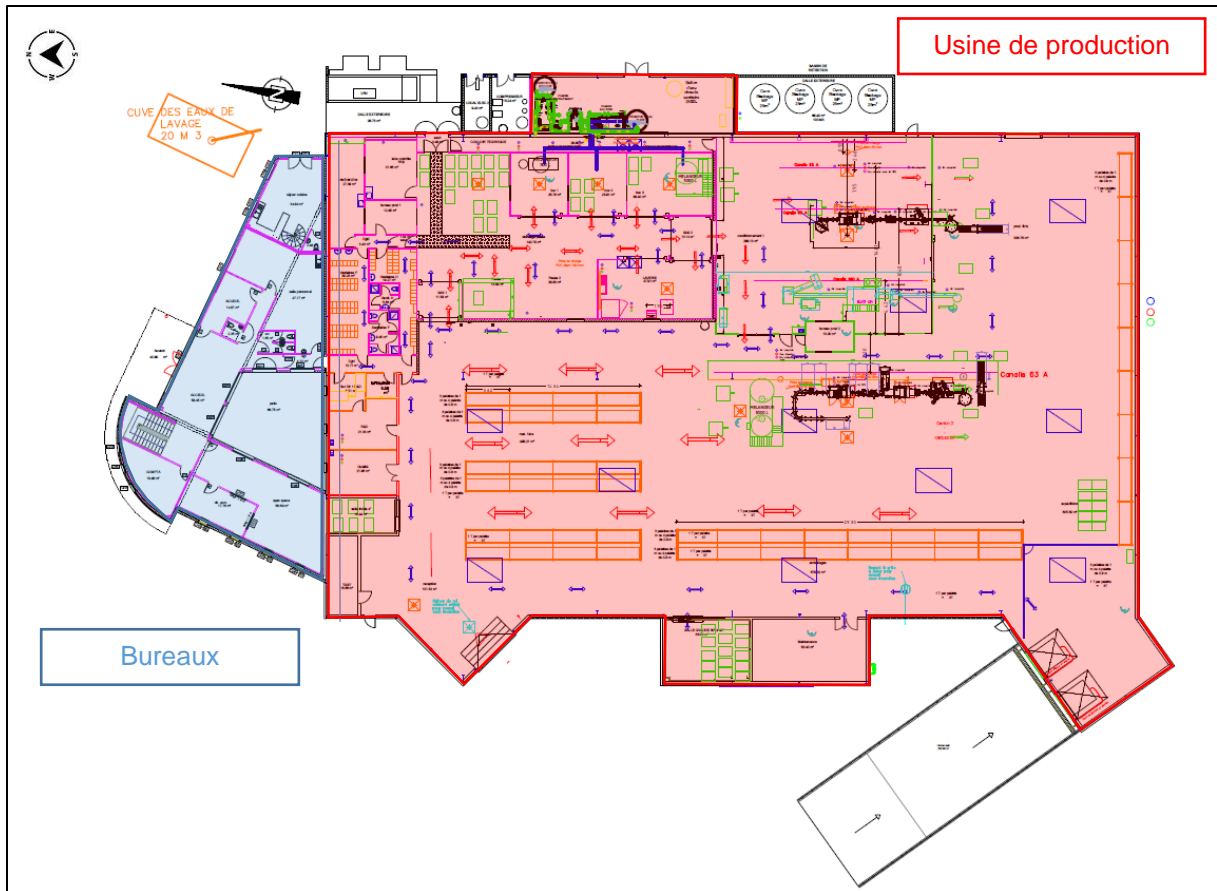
Découpage de l'usine en plan RDC – échelle 1/250
